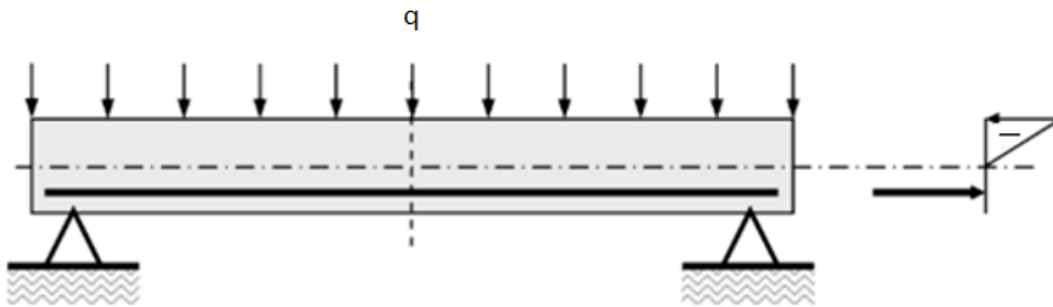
Viga de hormigón armado sometida a una carga distribuida q (4).
